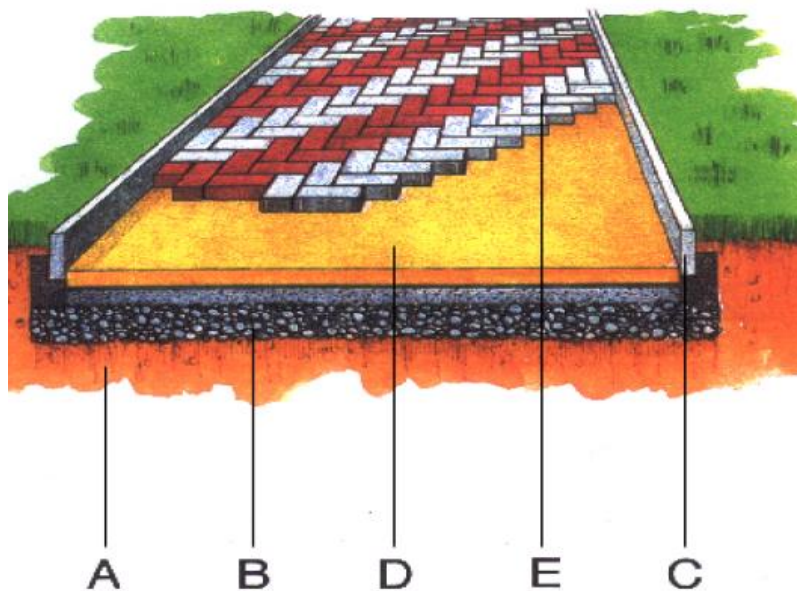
Etapas en la ejecución de un pavimento de adoquines
